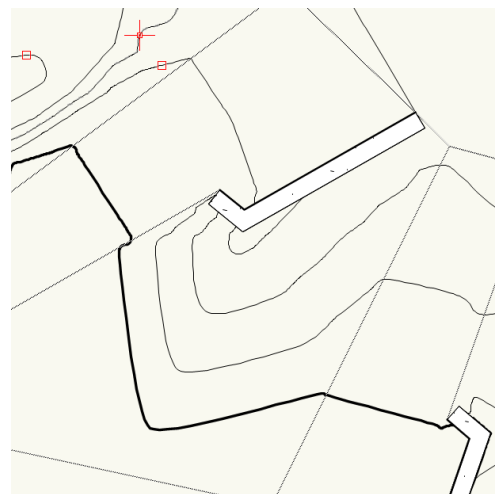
Vista em planta das alterações à modelação criadas pelo muro de contenção
